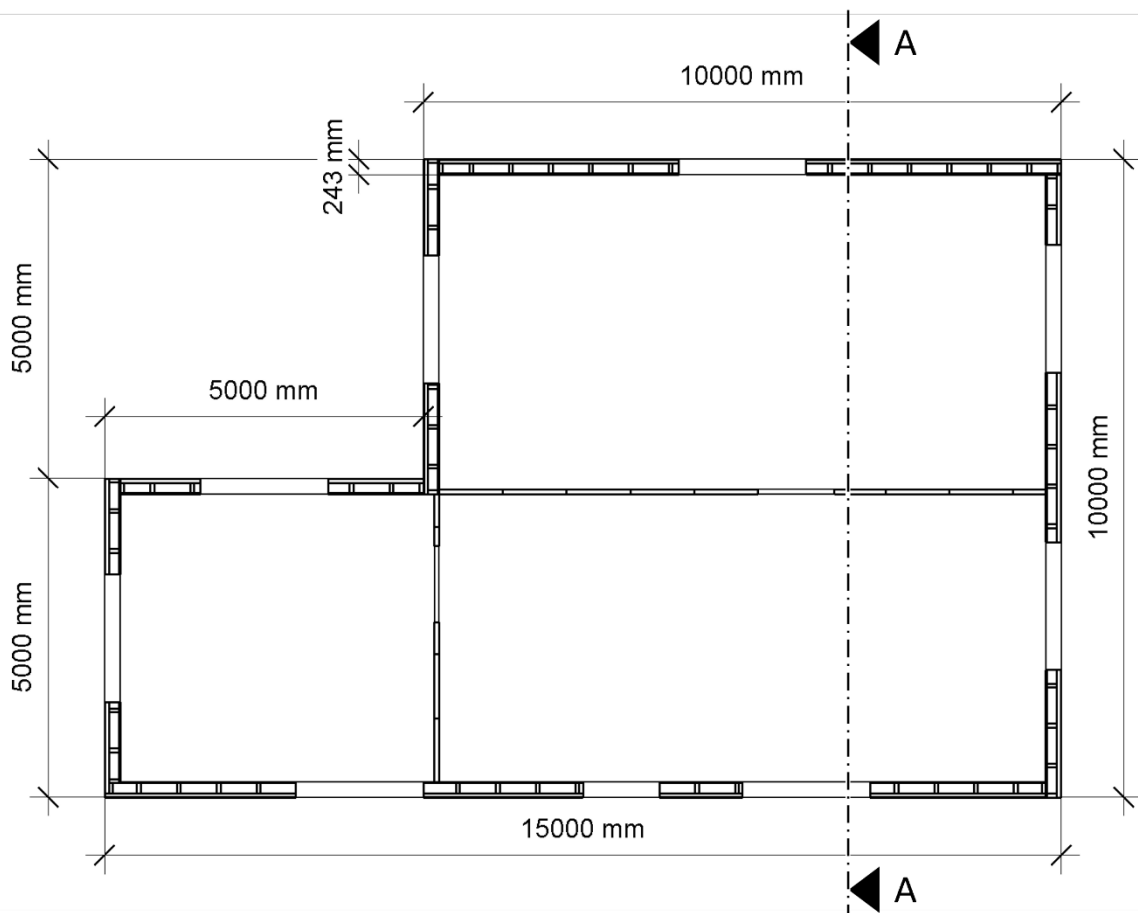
Grundriss des Beispielgebäudes (Erdgeschoss) in Autodesk Revit
